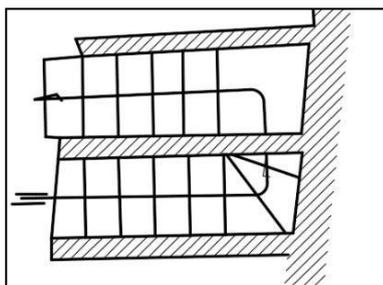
plan d'escalier. Source : plan modifié par l'auteur
